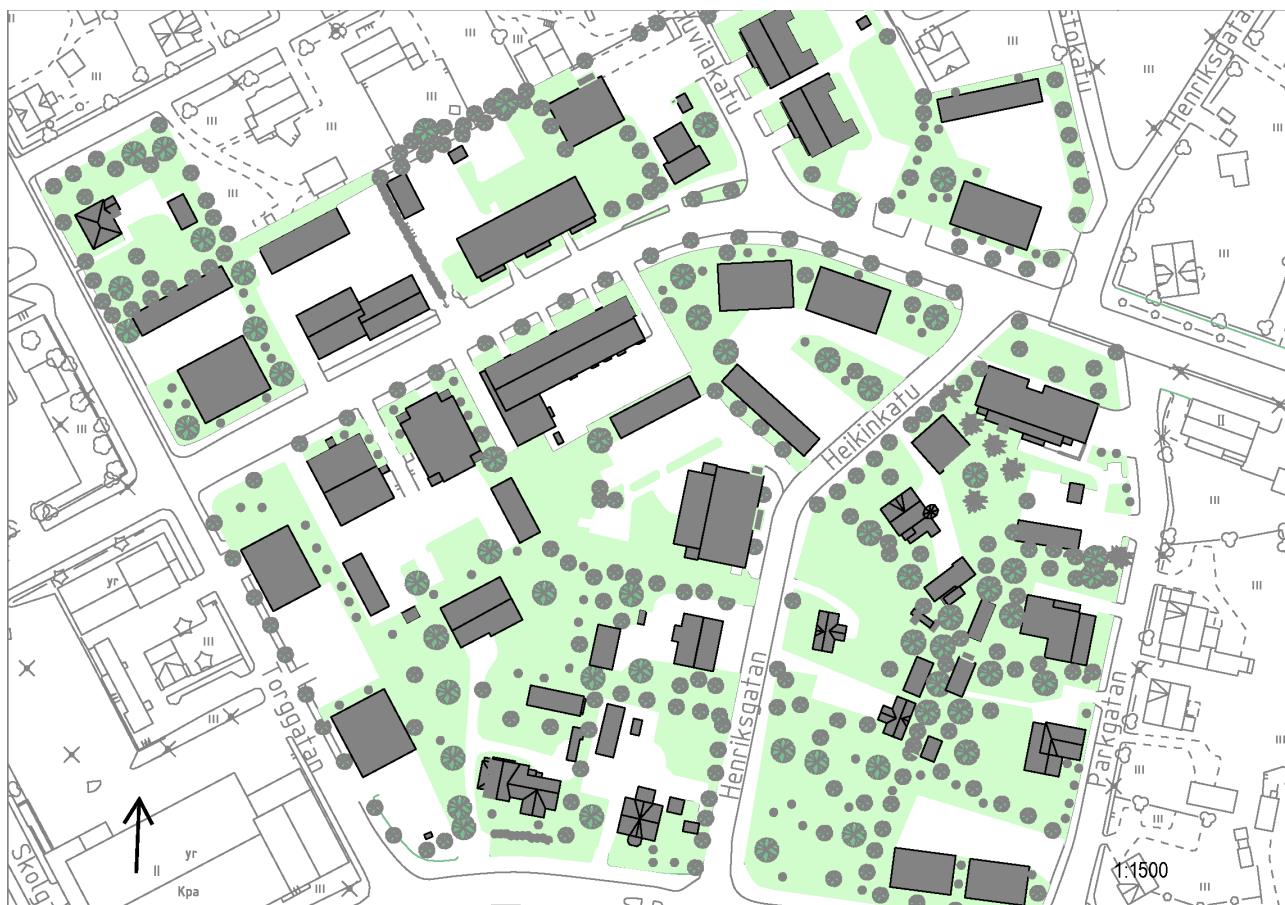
En illustration av planområdet. Illustrationen visar hur den planerade nybyggnationen kunde passa in i byggnadsbeståndet. Grönskan kommer att ha en framträdande roll i stadsbilden.
